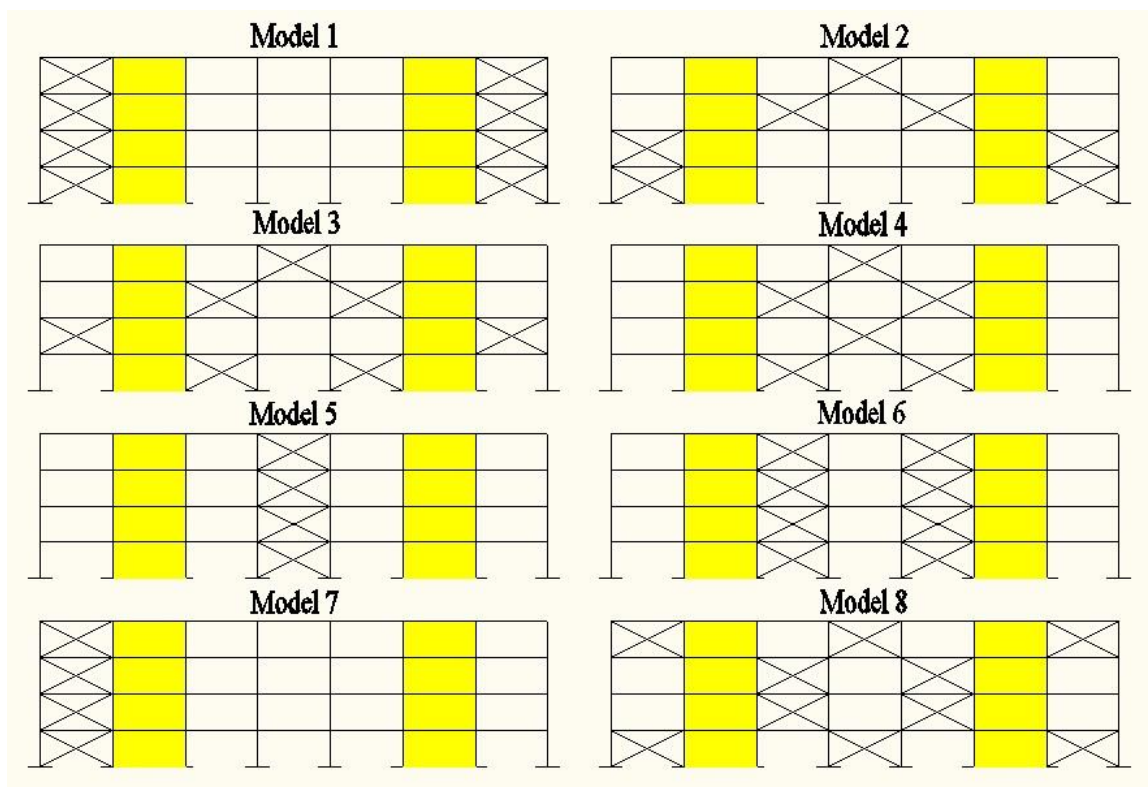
Modele de amplasare a contravântuirilor în elevație
